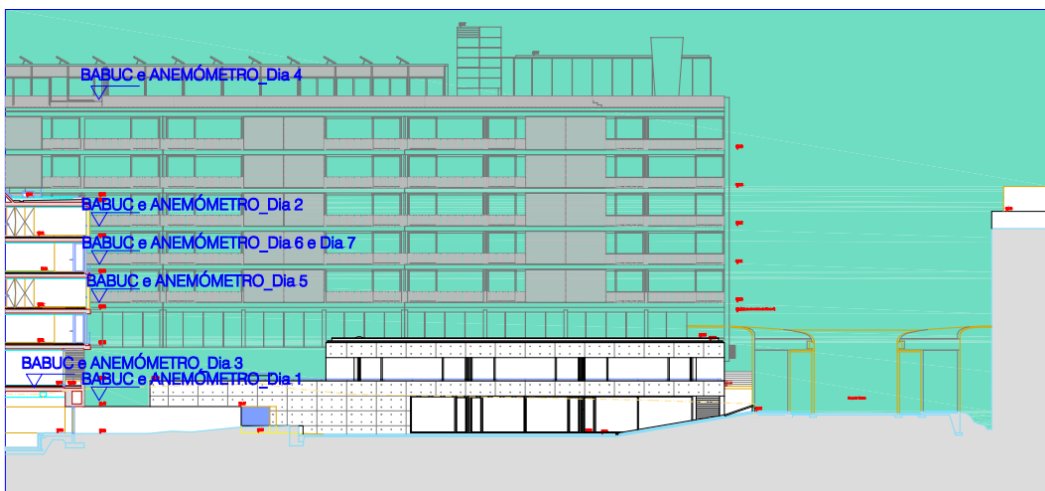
Localização dos aparelhos de medições – Vista ponte.
